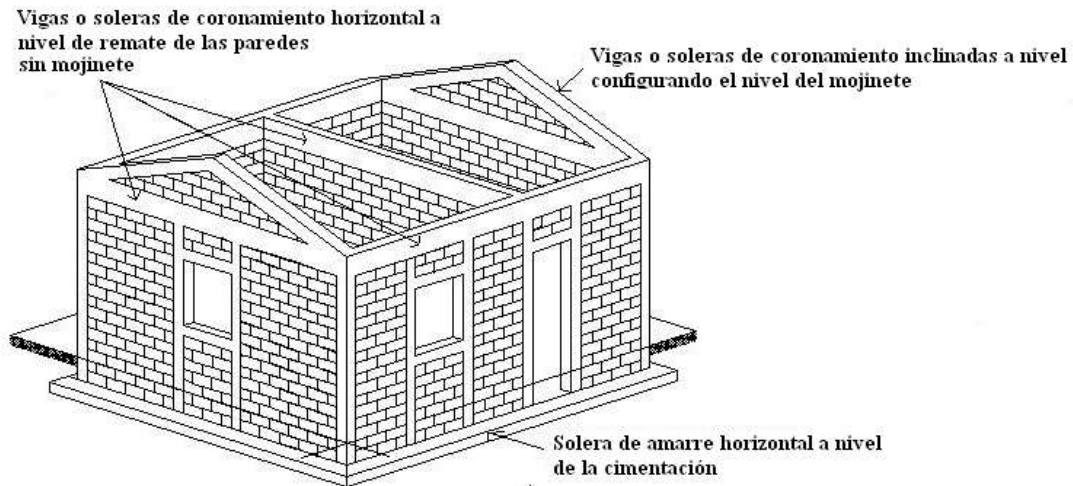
Vigas o soleras de amarre en viviendas de una planta - Opción 1.
